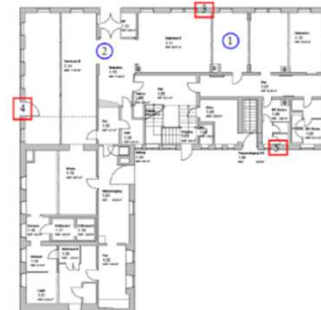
Lage und Nr. der Bauteilöffnungen an der Decke über EG (blau; Deckenöffnungen; rot; Auflageröffnungen)
